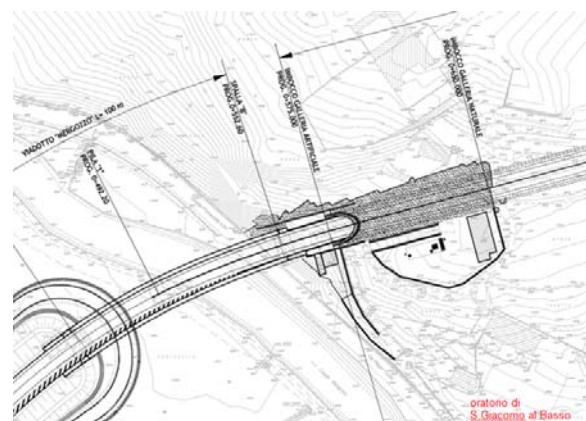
Planimetria del viadotto e dell'imbocco in galleria di Mergozzo
